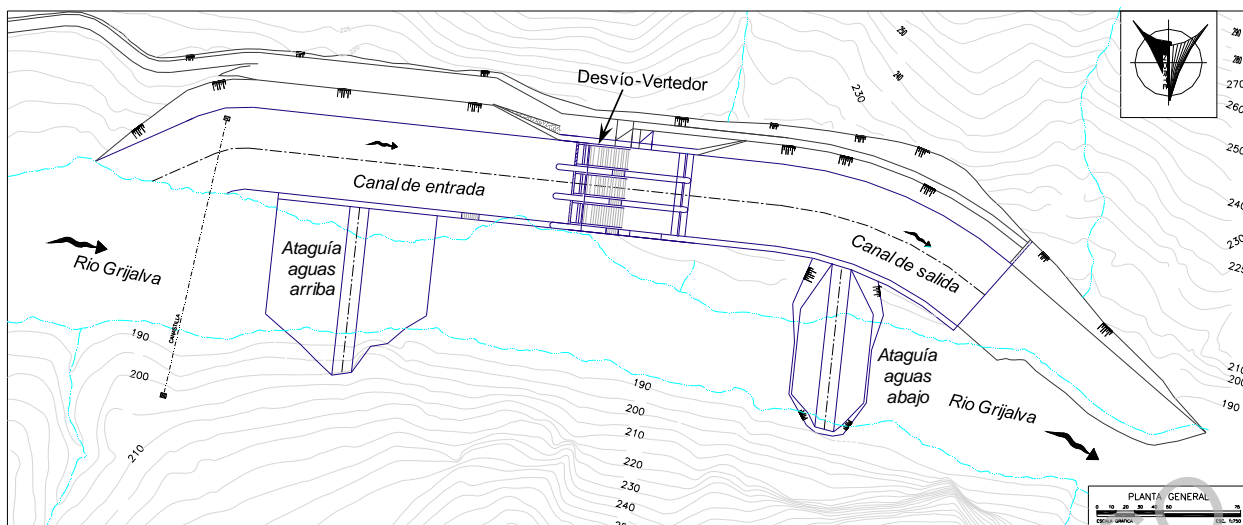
Figura 2.8 Planta obra de desvío vertedor
